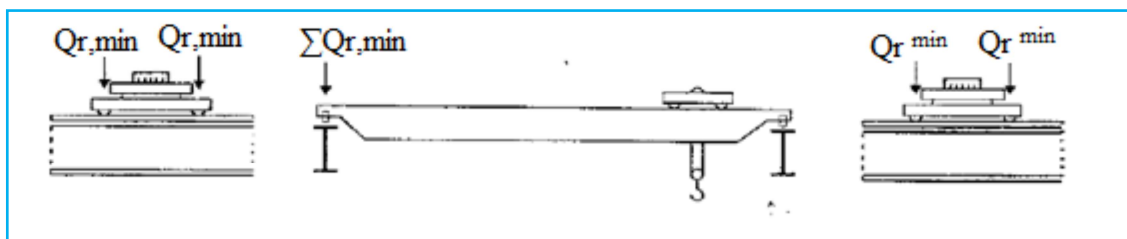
Disposition de charge de l'appareil de levage à vide pour obtenir un chargement minimal sur la poutre de roulement
